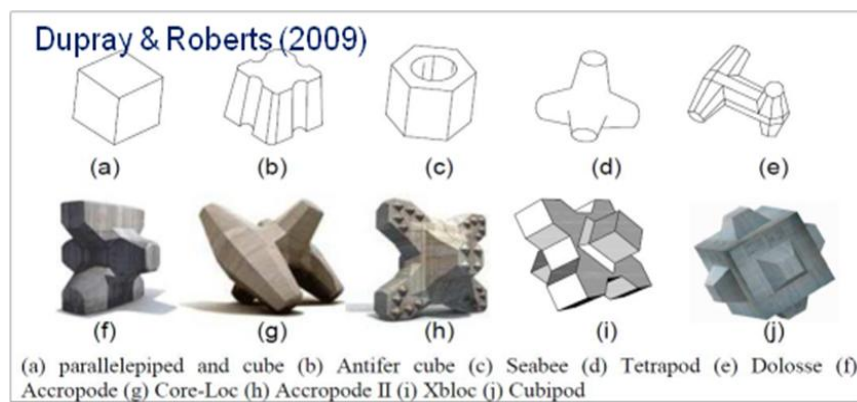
Elementos prefabricados de hormigón para mantos de diques en talud.
